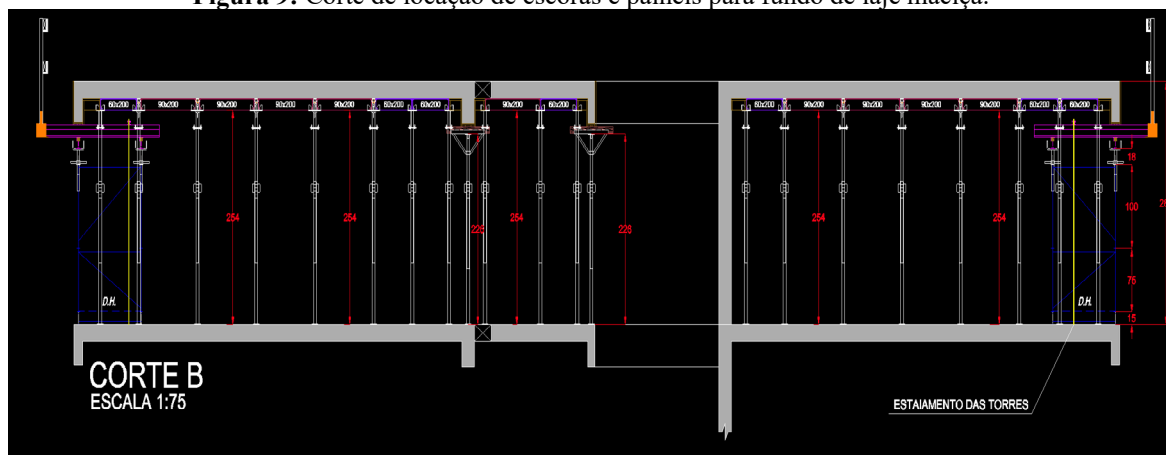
e 9, planta de locação e corte das escoras e painéis para o fundo lajes maciça.
